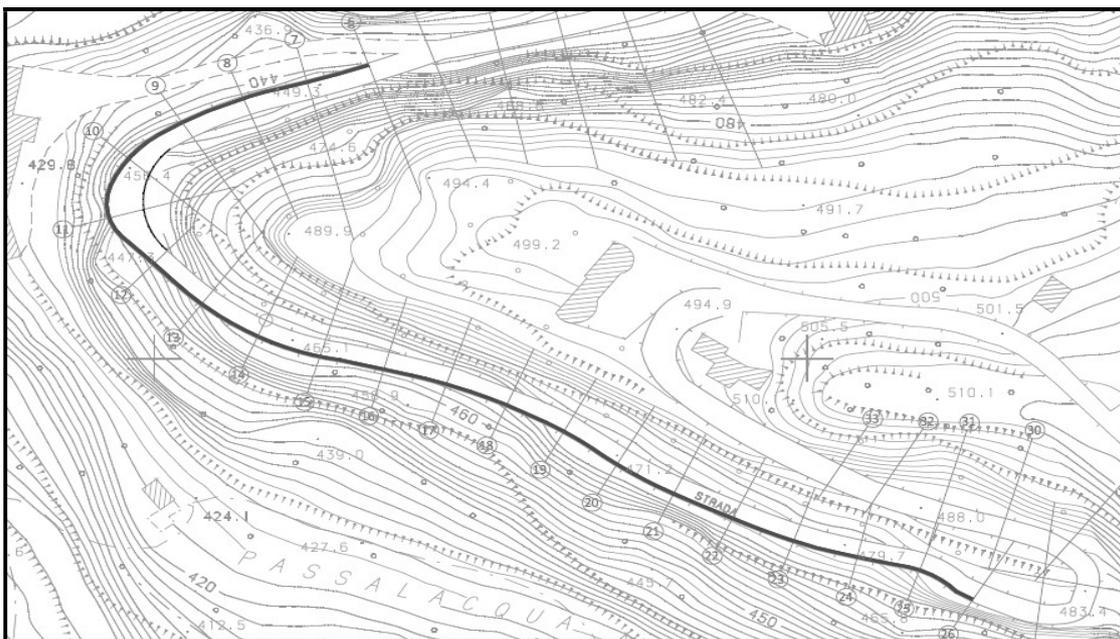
TAV.2 Planimetria di progetto-piastra trasversale
